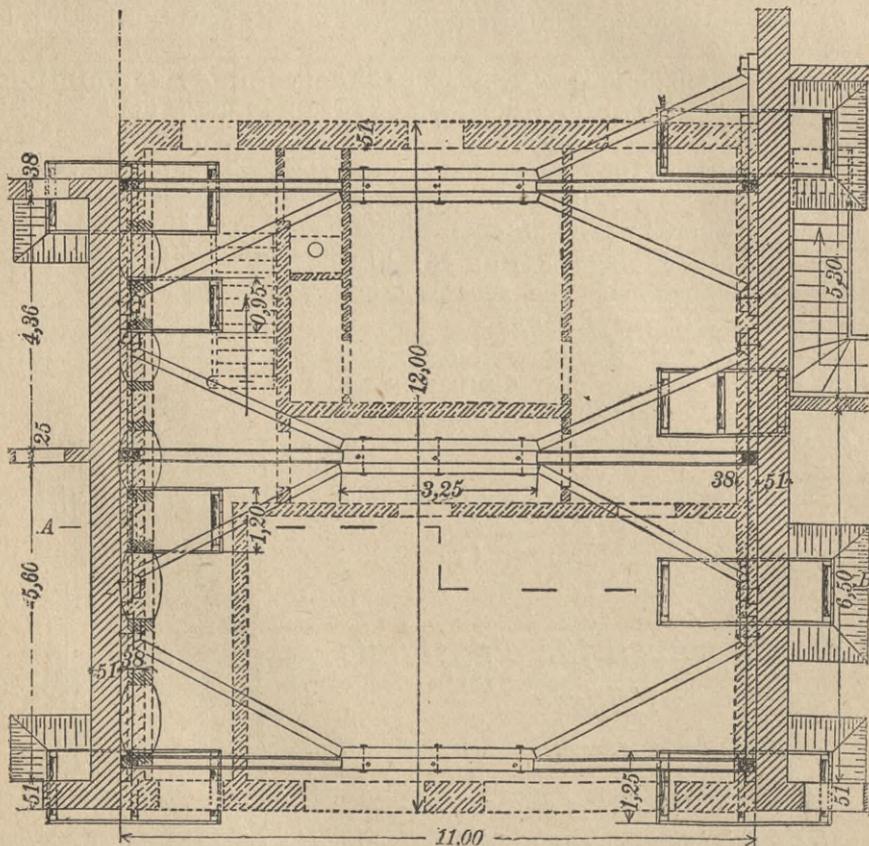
Gründung eines eingebauten Hauses (Grundriß).
